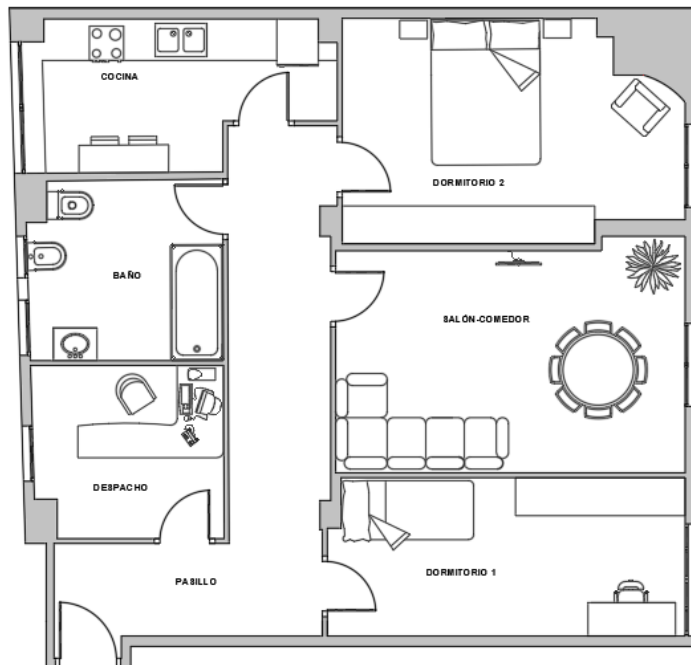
Plano de la vivienda reformada. Fuente propia
